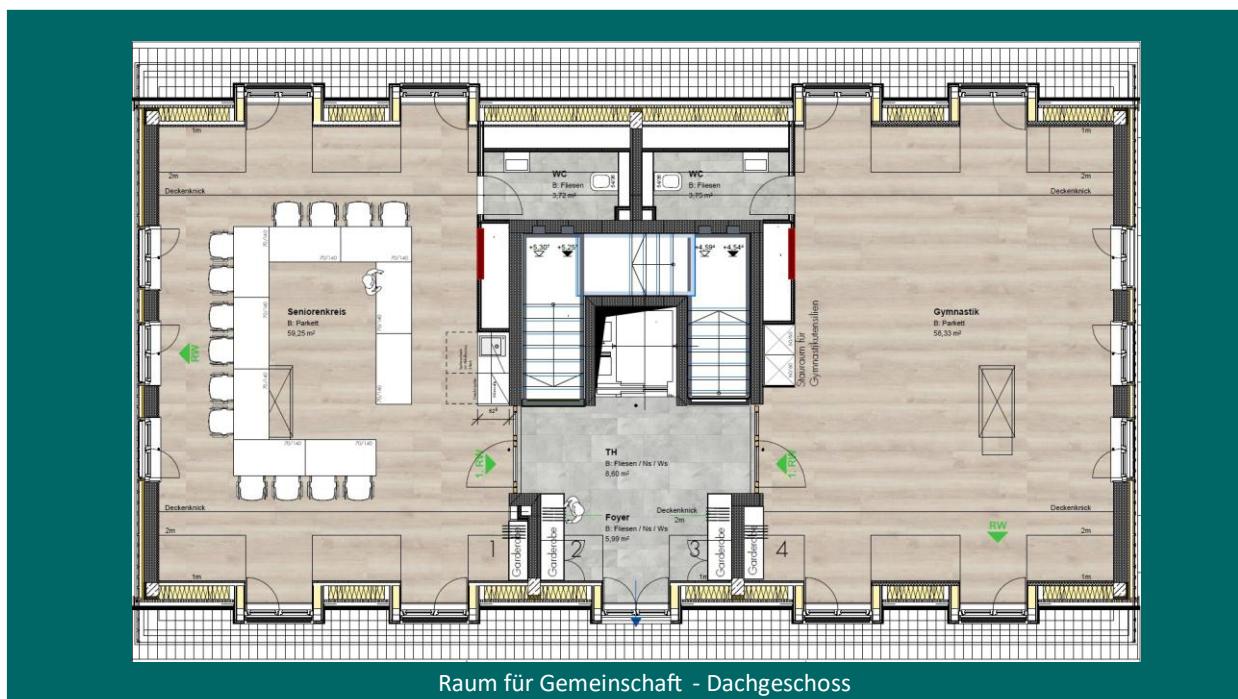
Grundriss Dachgeschoss des neuen Bürgerhauses in Burgoberbach
